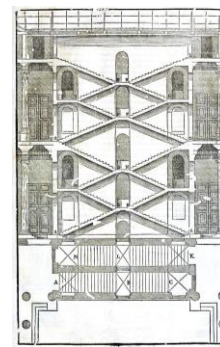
Alçado e planta de escadas zigzag de Palladio (Palladio, 1570)
